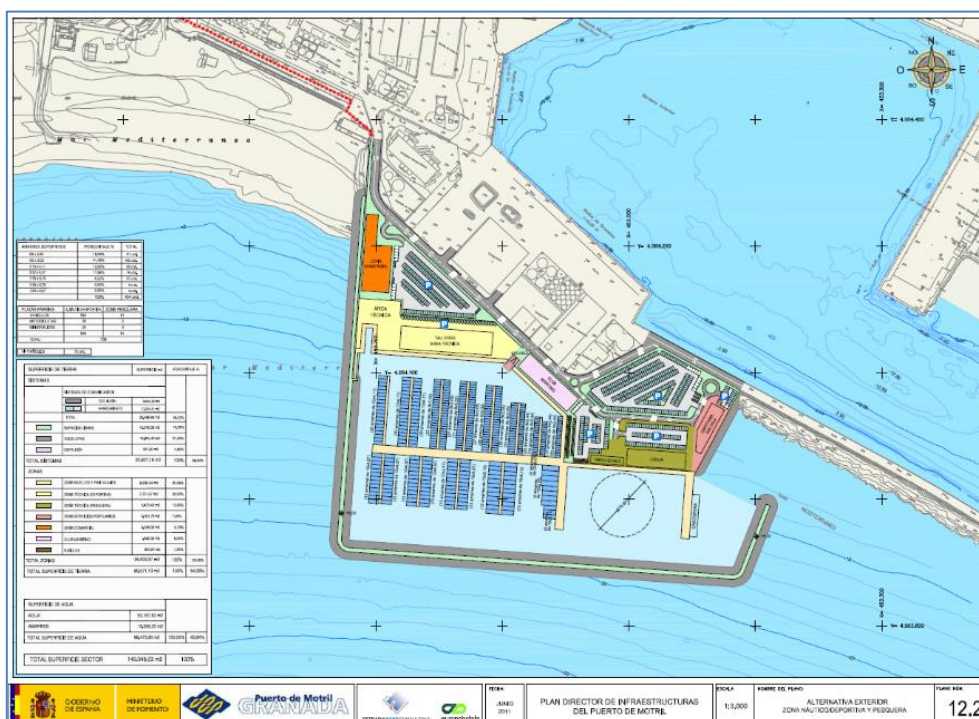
Planta de la zona pesquero-deportiva de la Alternativa Exterior
